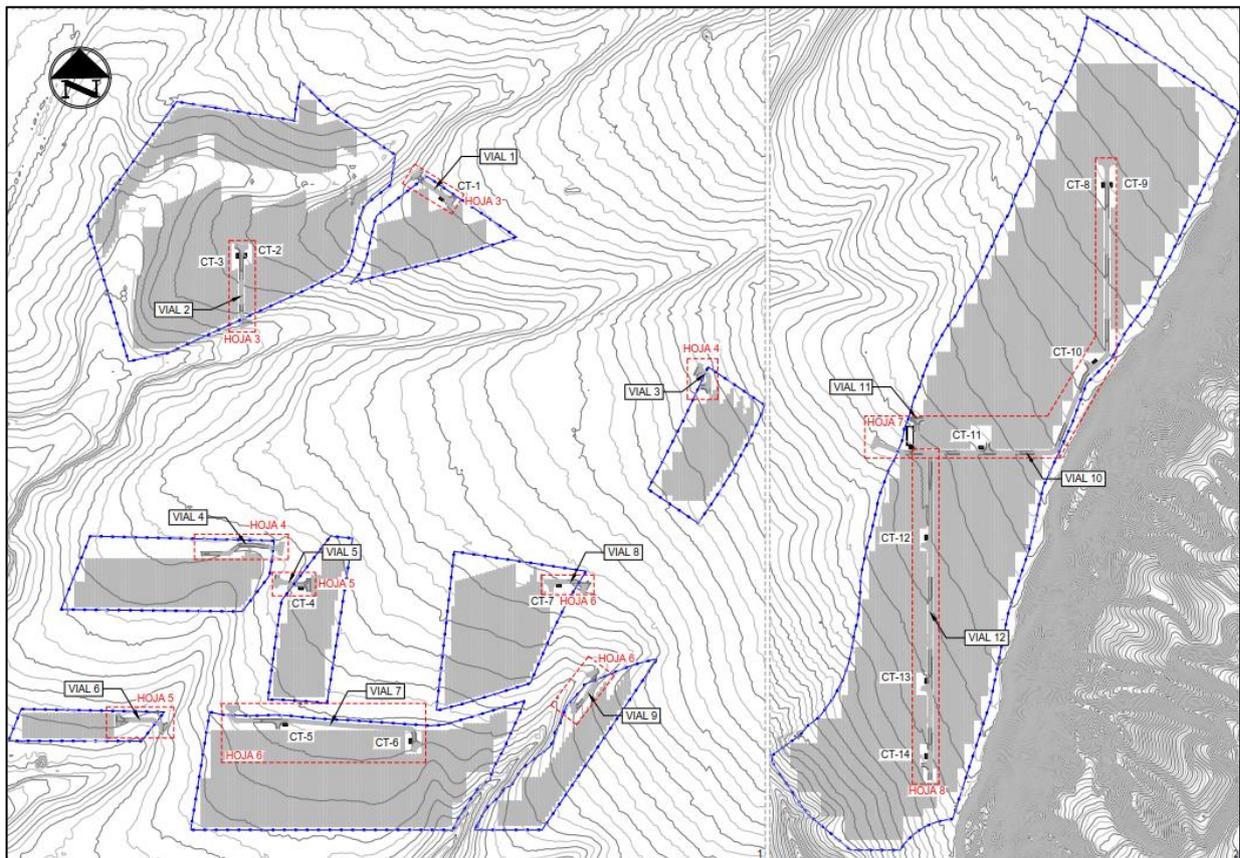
Red de viales internos del PFV San Peirón I. Fuente_ Proyecto modificado de la planta solar San Peirón I.
